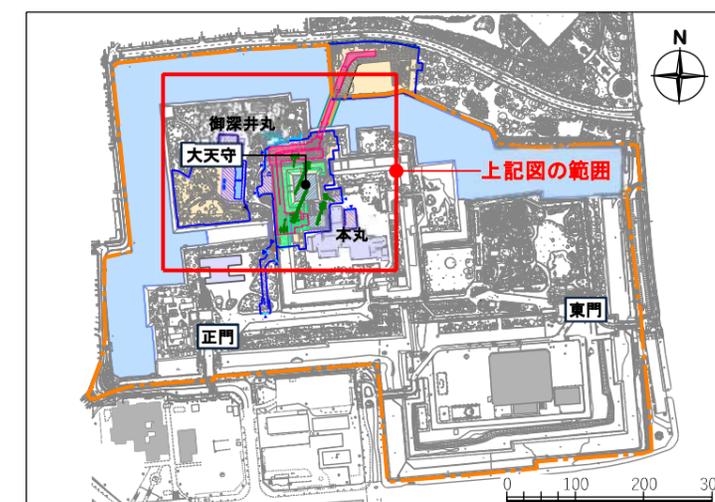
現天守閣解体工事時の平面図(敷地全体)
